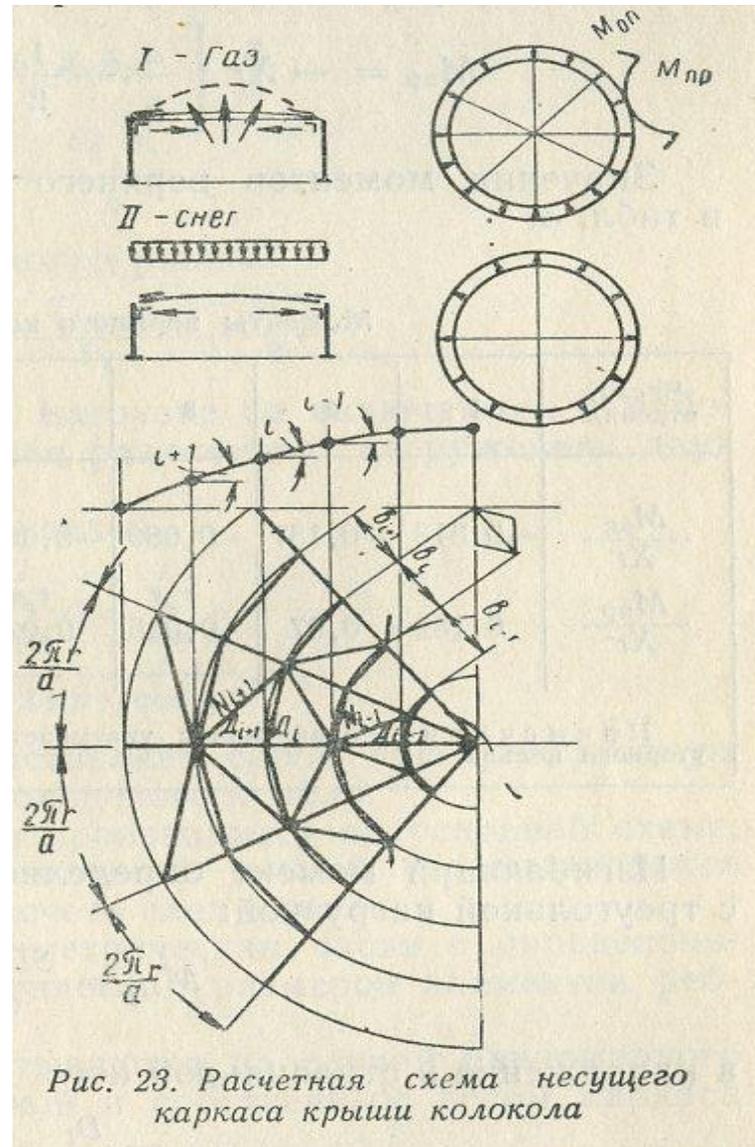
Расчетная схема несущего каркаса крыши колокола
